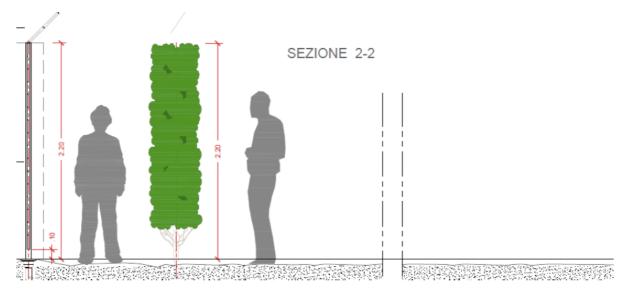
Prospetto recinzione perimetrale con mitigazione – sistema da adottatare.
